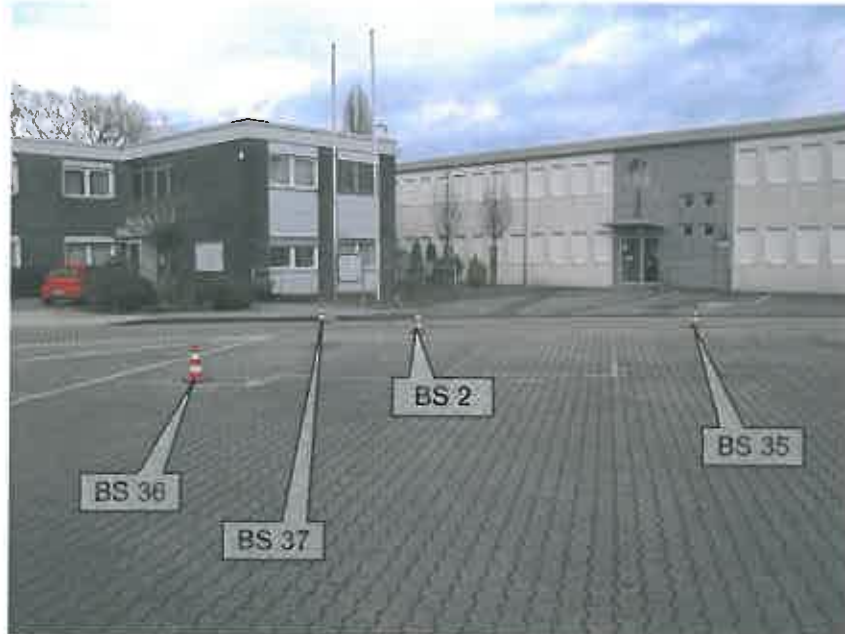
Blickrichtung ~ ONO; Bereiche der BS 2, BS 35, BS 36 und BS 37 (Markierungen)
